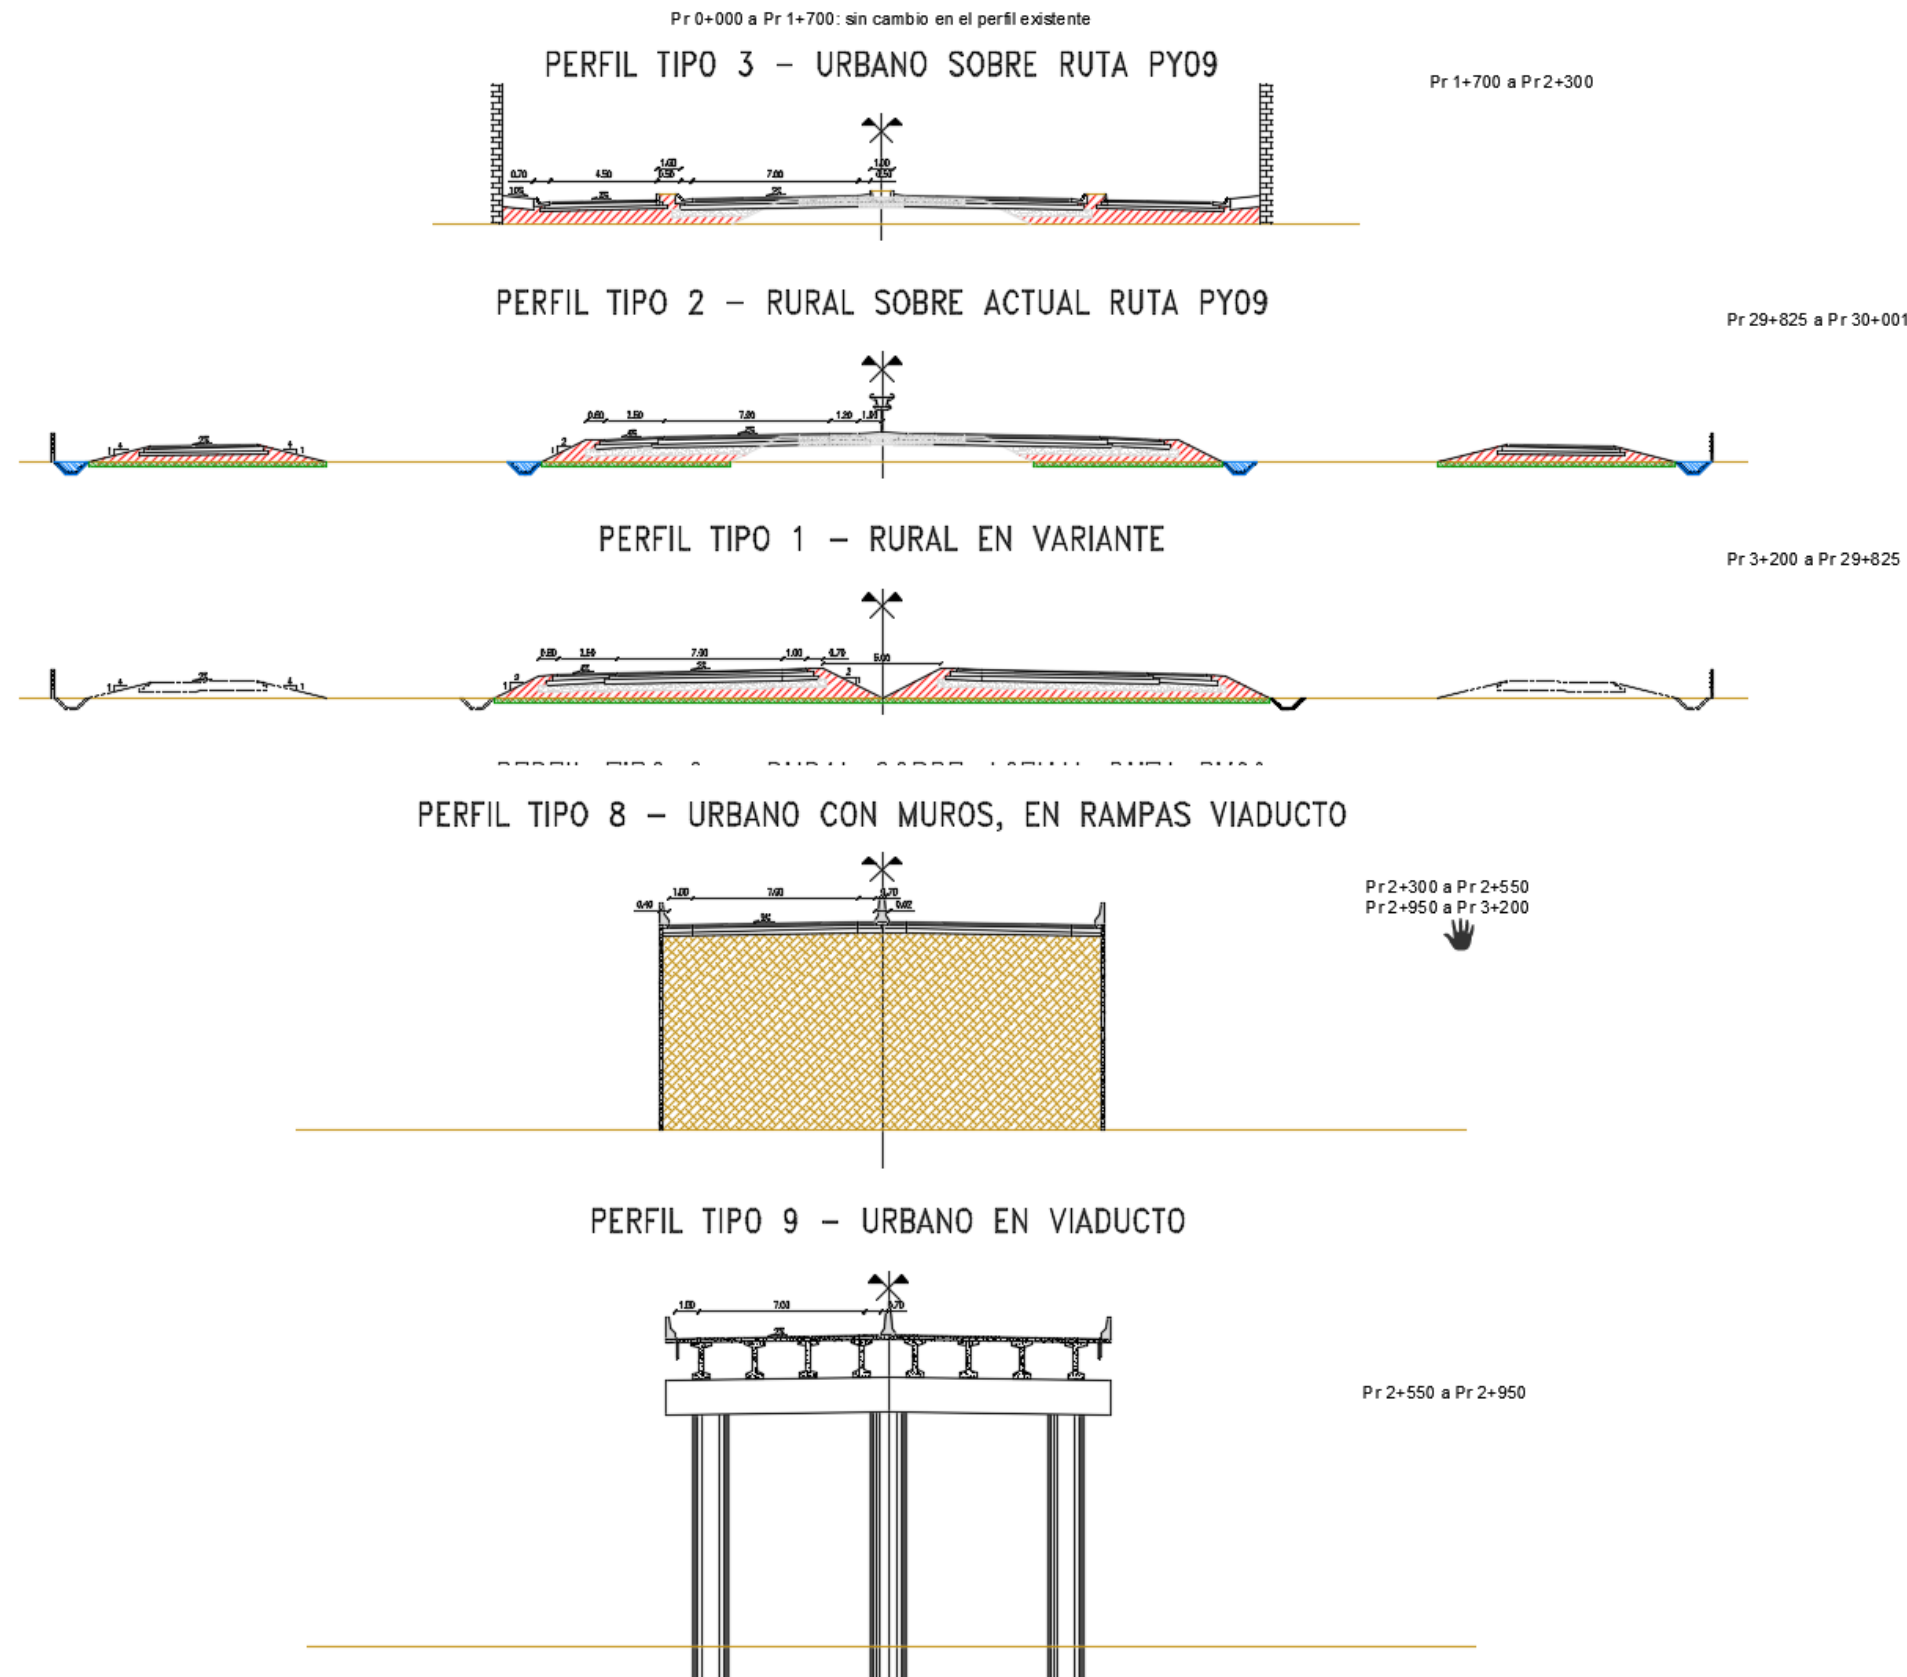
Secciones transversales típicas de la Alternativa E
